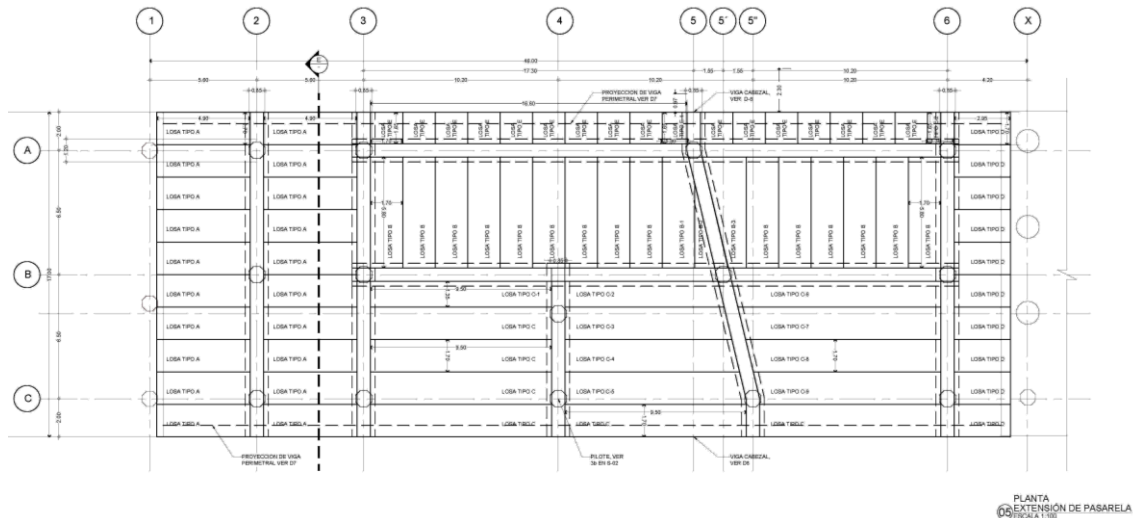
Vista en planta de la extensión de la pasarela del muelle.
